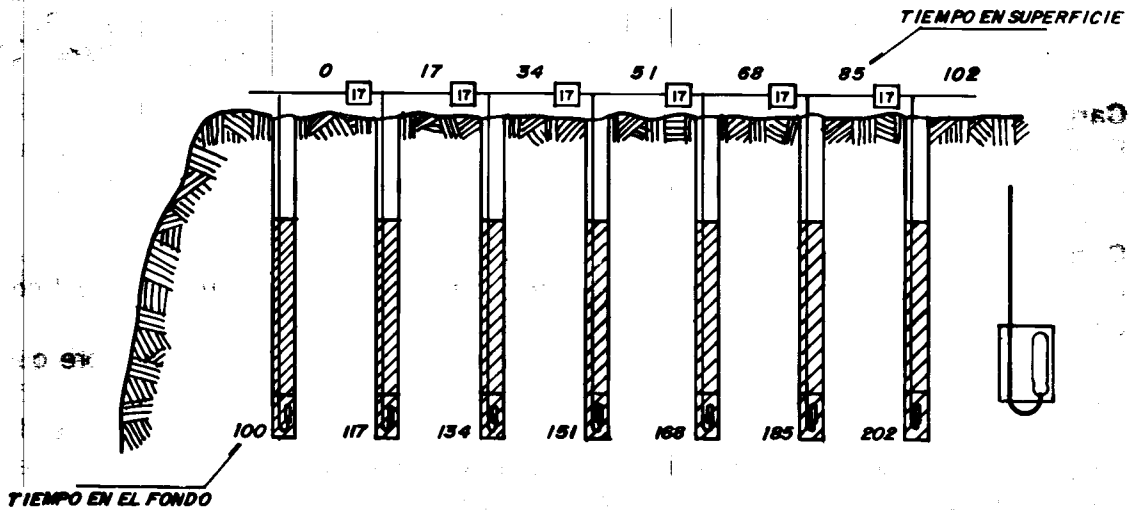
Tiempos de retardo en superficie y fondo del barreno.
